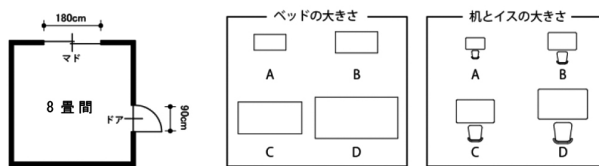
平面図 図8 8畳間の平面図と家具を比較した際の適切な大きさ
